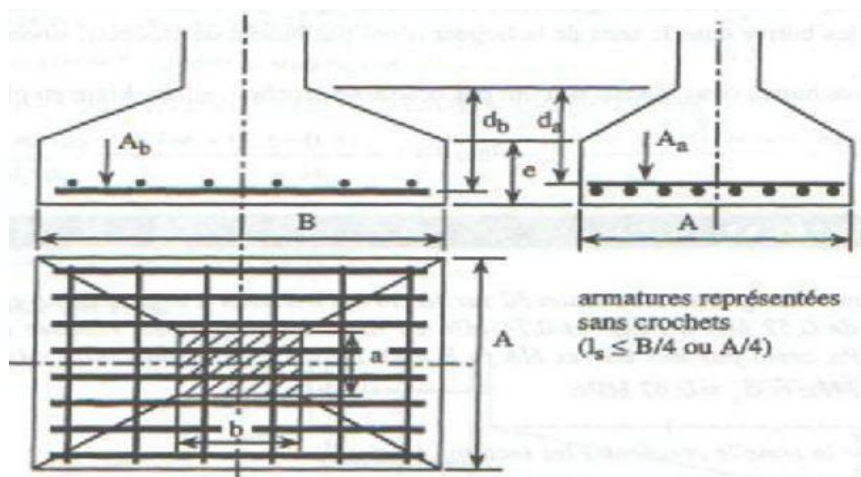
Semelle rectangulaire sous poteau rectangulaire
